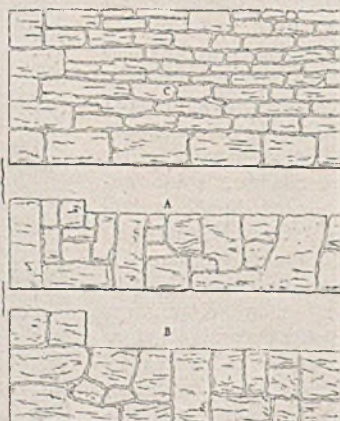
Mauerwerk in behauenen Bruchsteinen.
